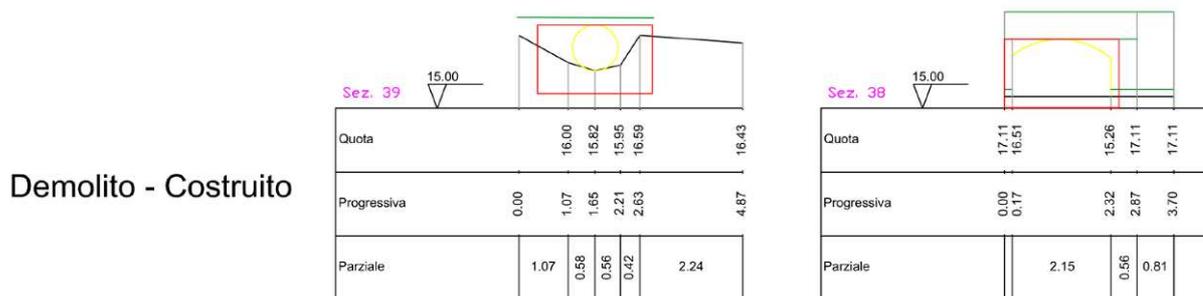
Sezioni di sovrapposto dell'intervento di sostituzione dell'attraversamento sotto via del Terzo
